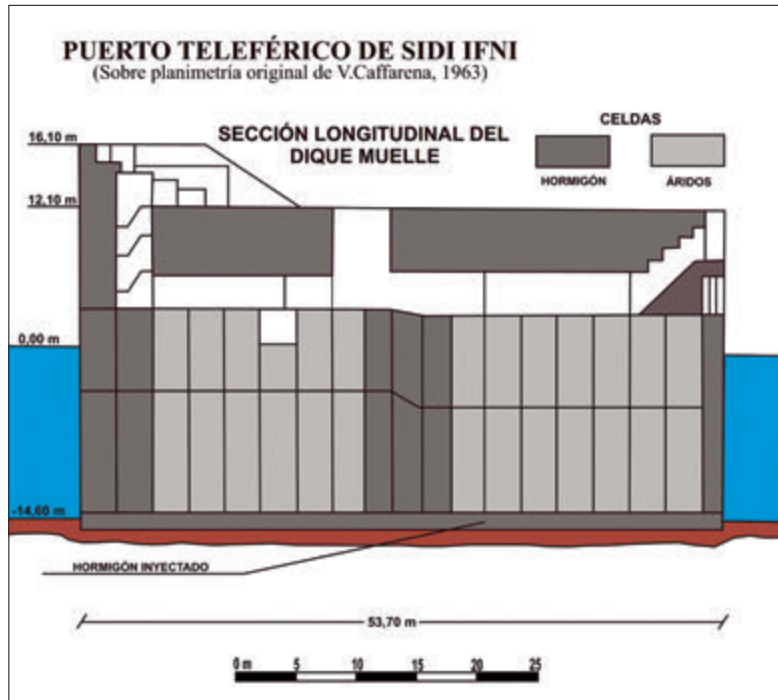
Plano del dique muelle realizado en Sidi Ifni (sobre planimetría original, Caffarena 1963:64).
